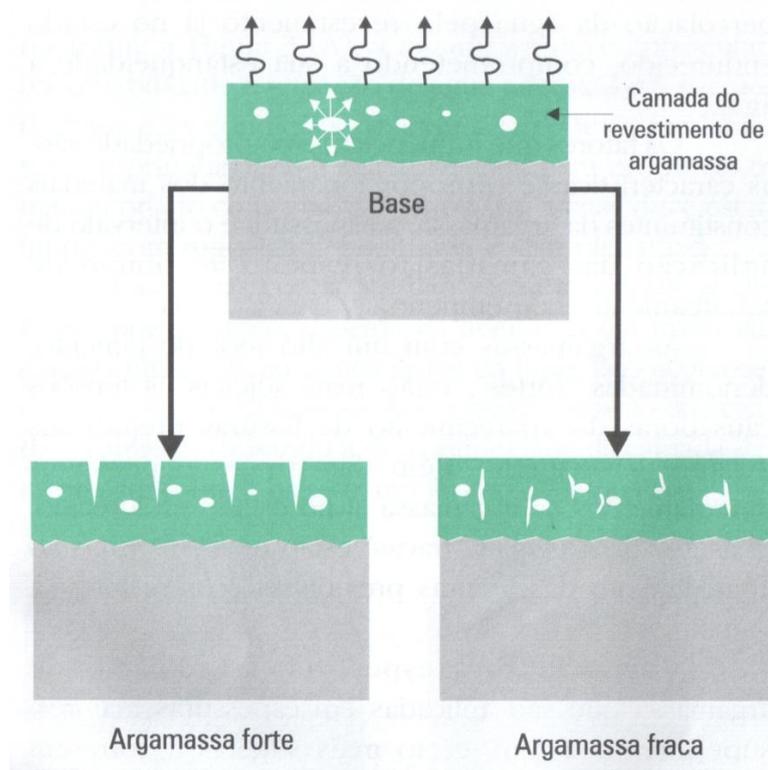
fissuração da argamassa por retração na secagem, argamassa com alto e baixo teor de cimento (BAÍA; SABBATINI, 2001, p. 20)
